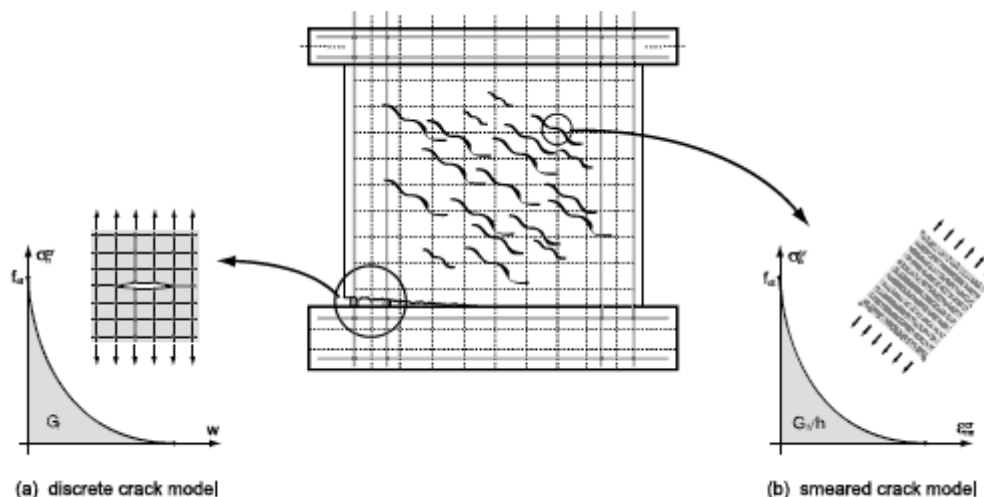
Modelos de fisuración del hormigón.
